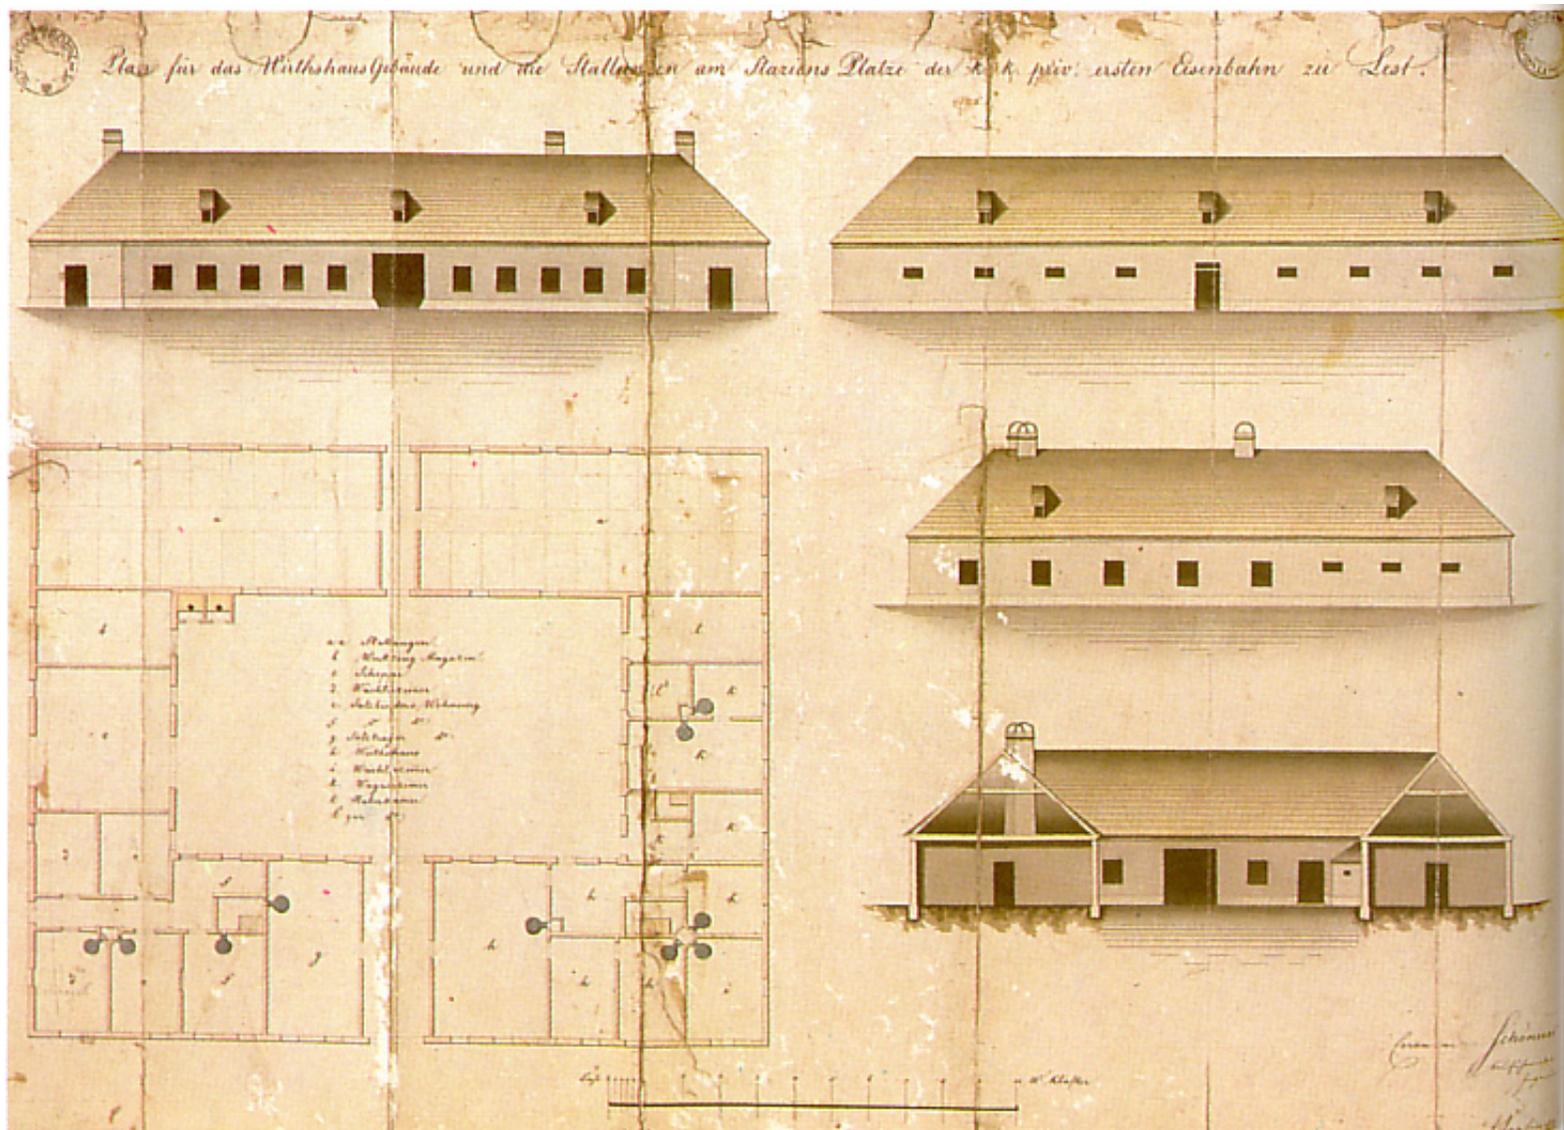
Plan für das Stationsgebäude in Lest, ursprüngliche Anlage von 1837/38.
